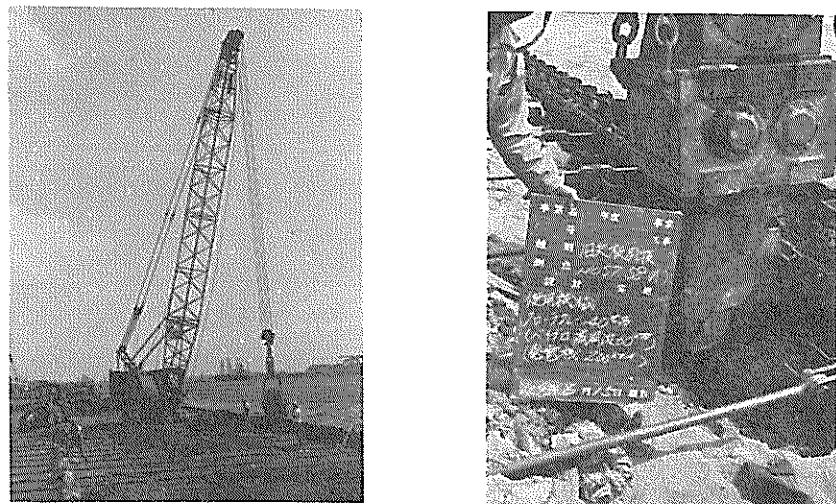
北埠頭 - 4.6 m 岸壁鋼矢板引き抜き状況
